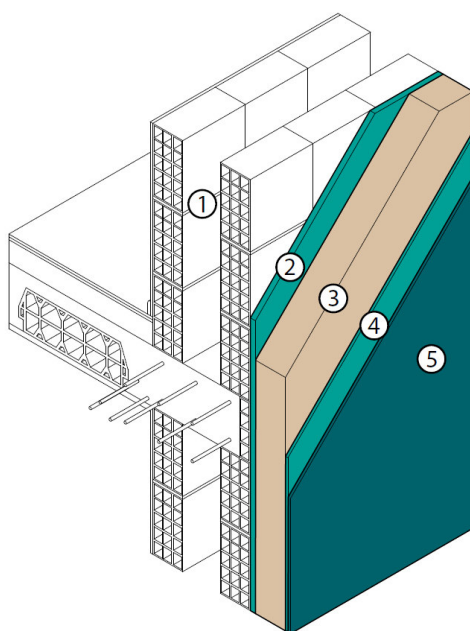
Schema costruttivo dell’intervento proposto (cappotto tradizionale)
